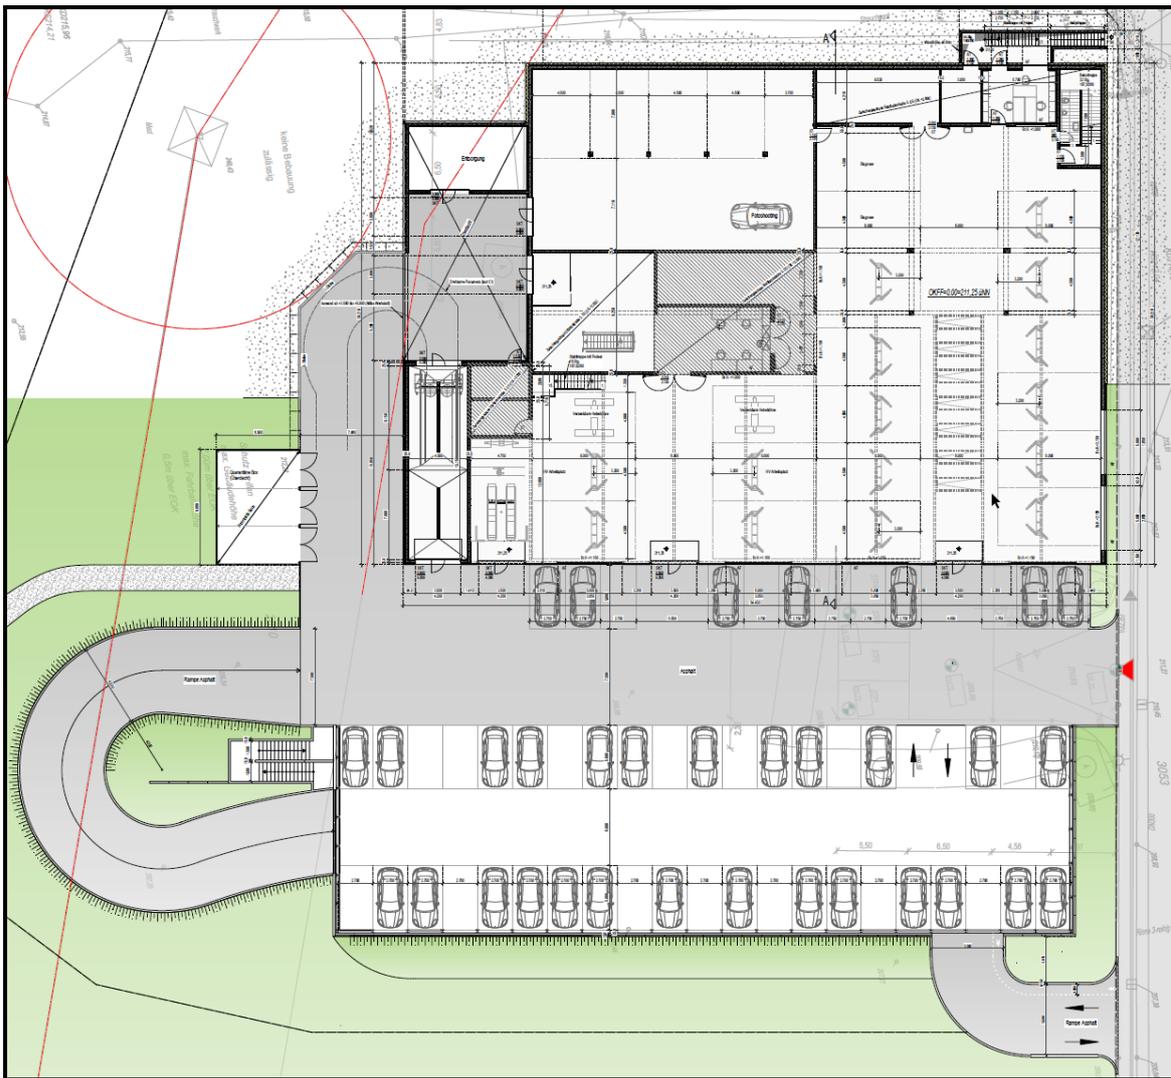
geplantes Vorhaben, Grundriss EG, Werkstatt, Bürogebäude und Parkhaus [17]
